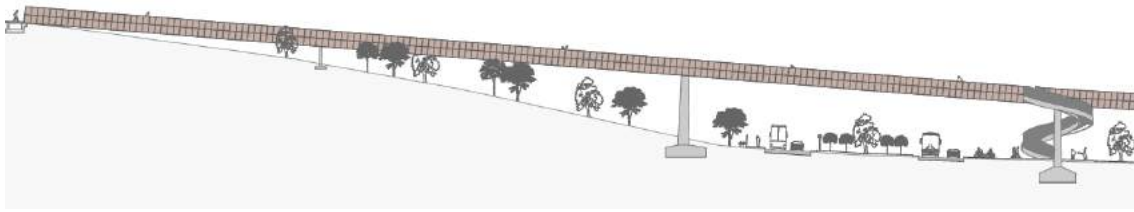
Recorte del plano “Detalles del perfil longitudinal” tramo PK 0+000.00 – PK 0+183.00
